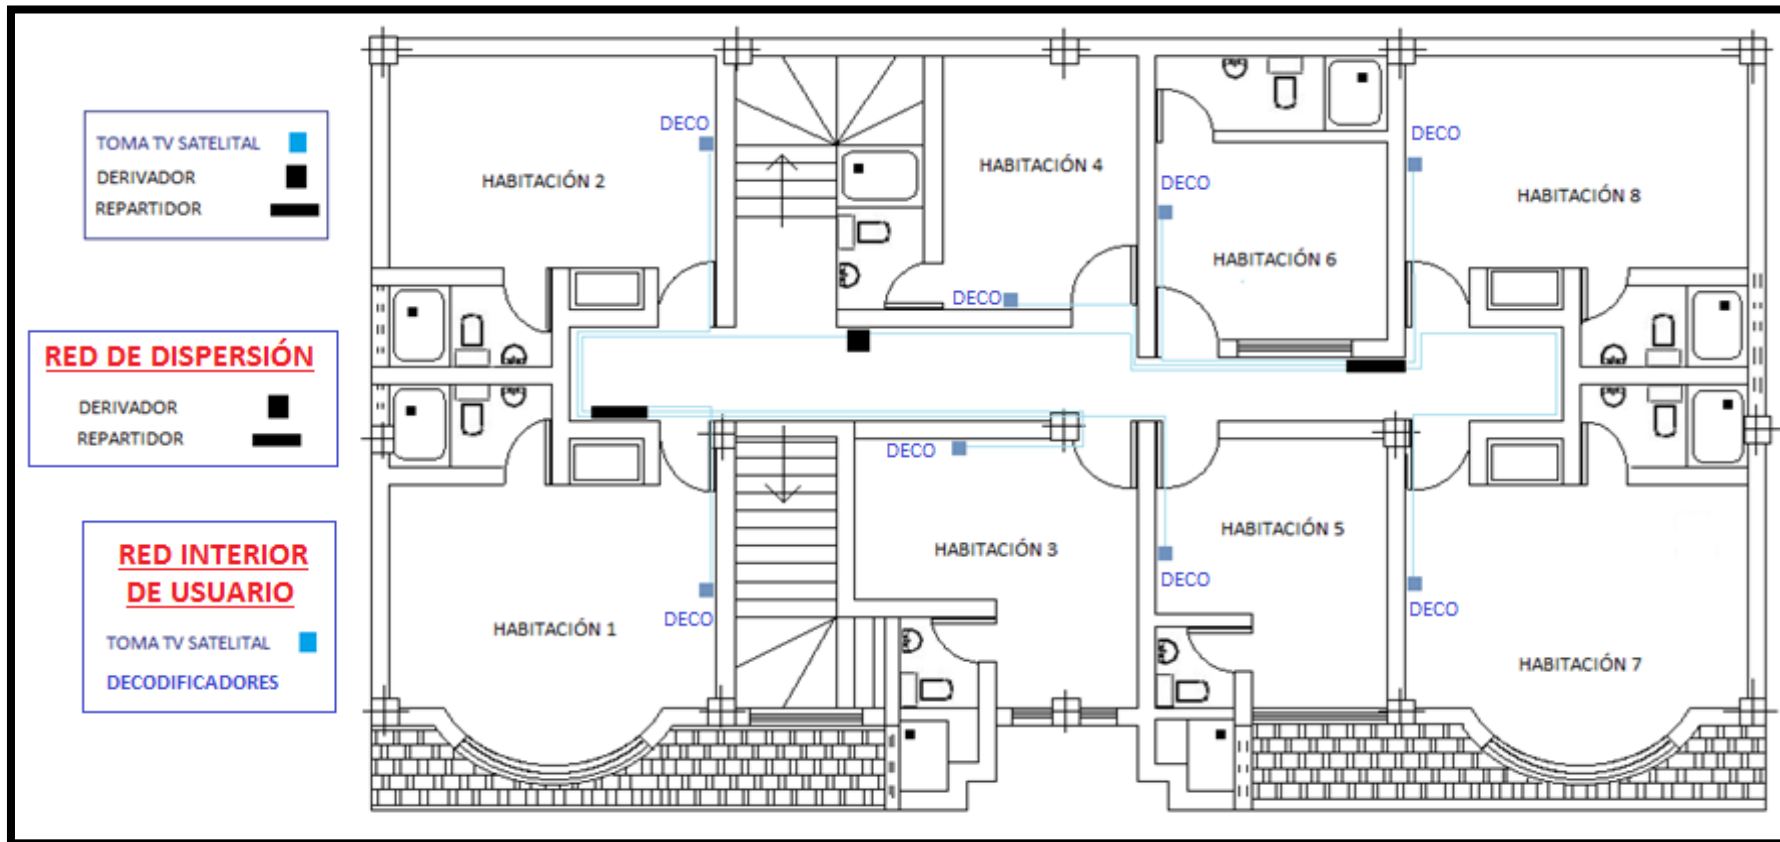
Puntos de TV satelital – Plano Primera Planta
